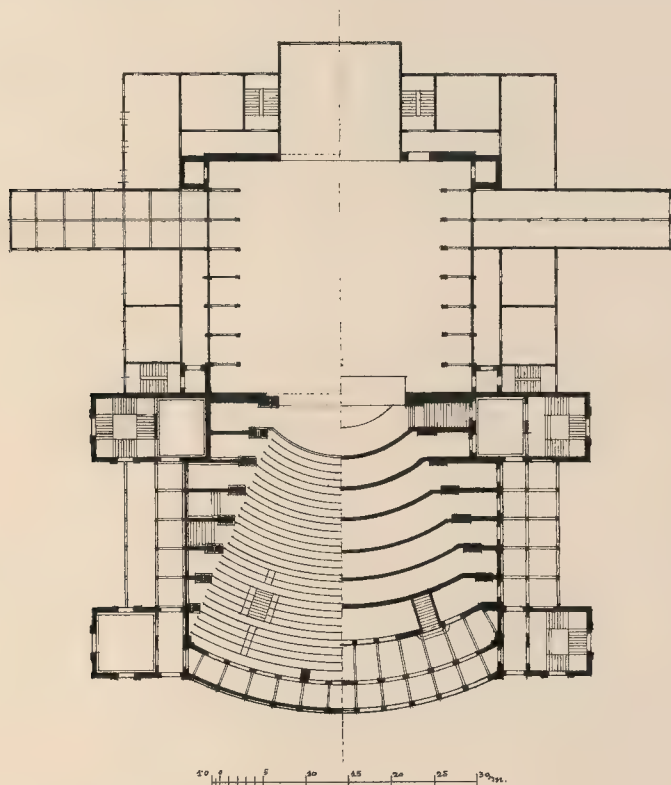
Grundriss des Festspielhauses zu Bayreuth.
